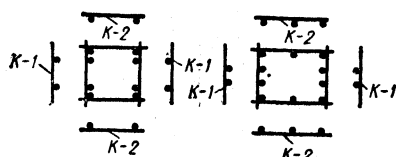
Поперечные сечения стоек, армированных двумя типами сварных каркасов.
